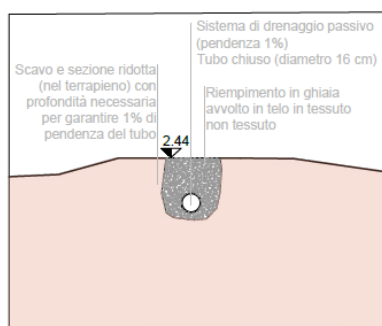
Estratto della tavola T25 Opere di completamento al Cantiere Pilota ed al sistema di drenaggio
